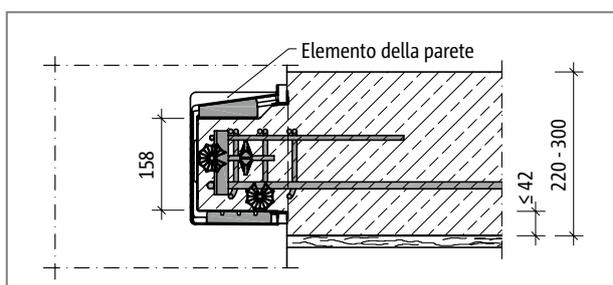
Schöck Tronsole® tipo Z, elemento previsto con cassero a perdere; l'intradosso del solaio più basso dell'elemento.
